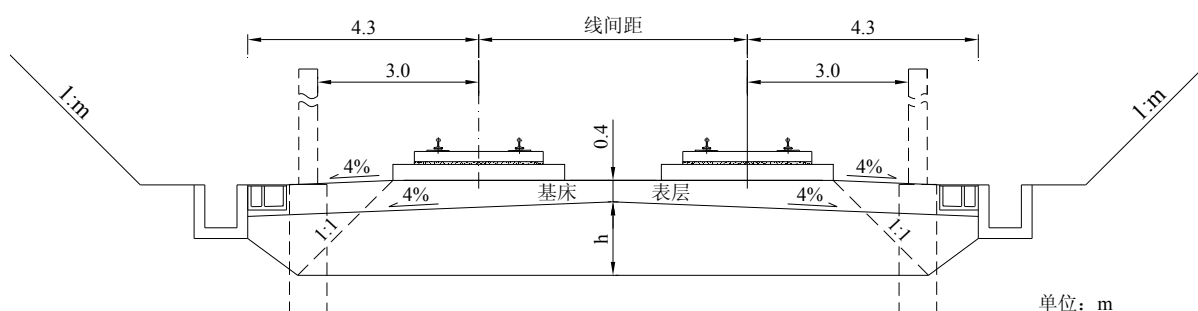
无砟轨道双线非硬质岩路堑标准横断面示意图
